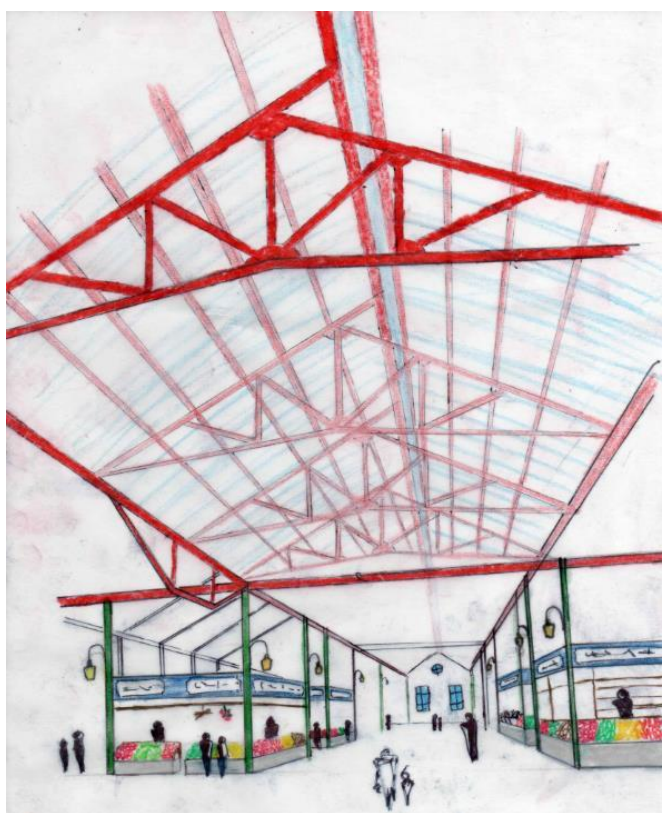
Boceto interior de las naves, zona comercial minorista
